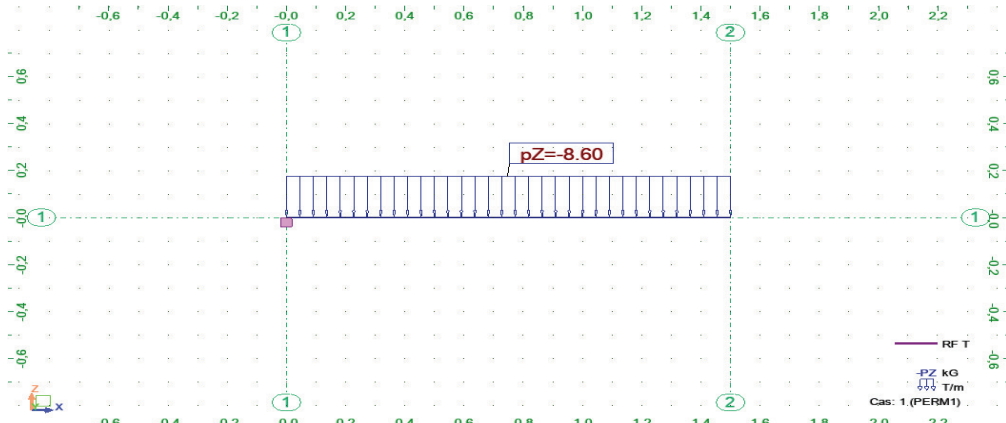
Schéma statique de la poutre tassement d'une pile de blocs
